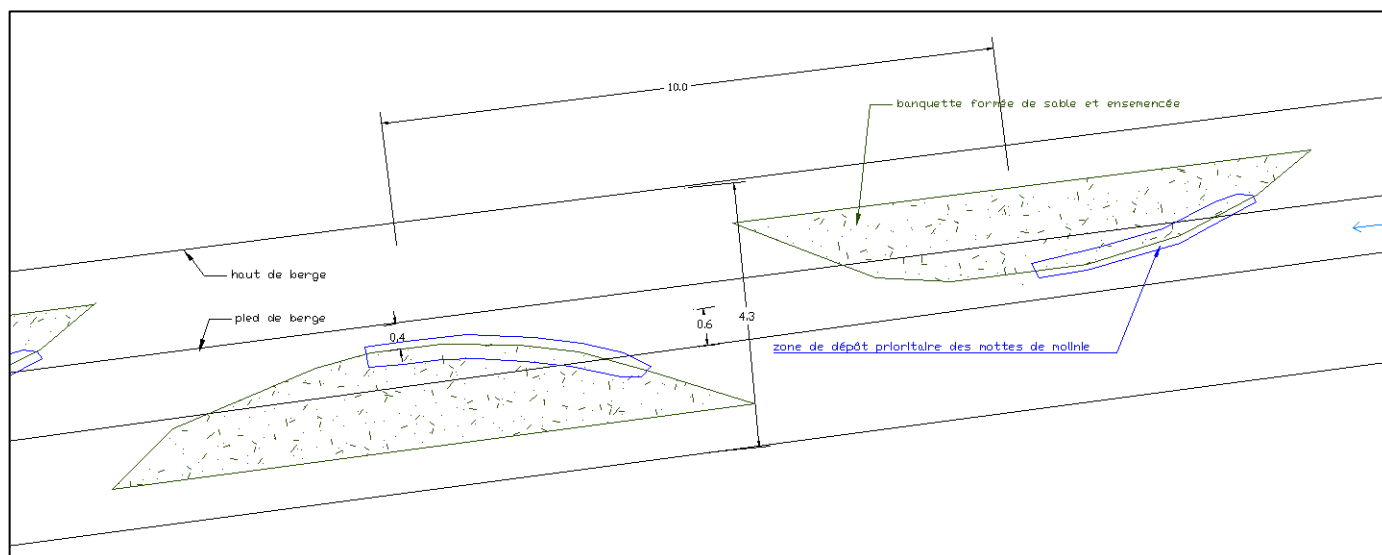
vue en plan du positionnement possible des banquettes sur le Vigneau
